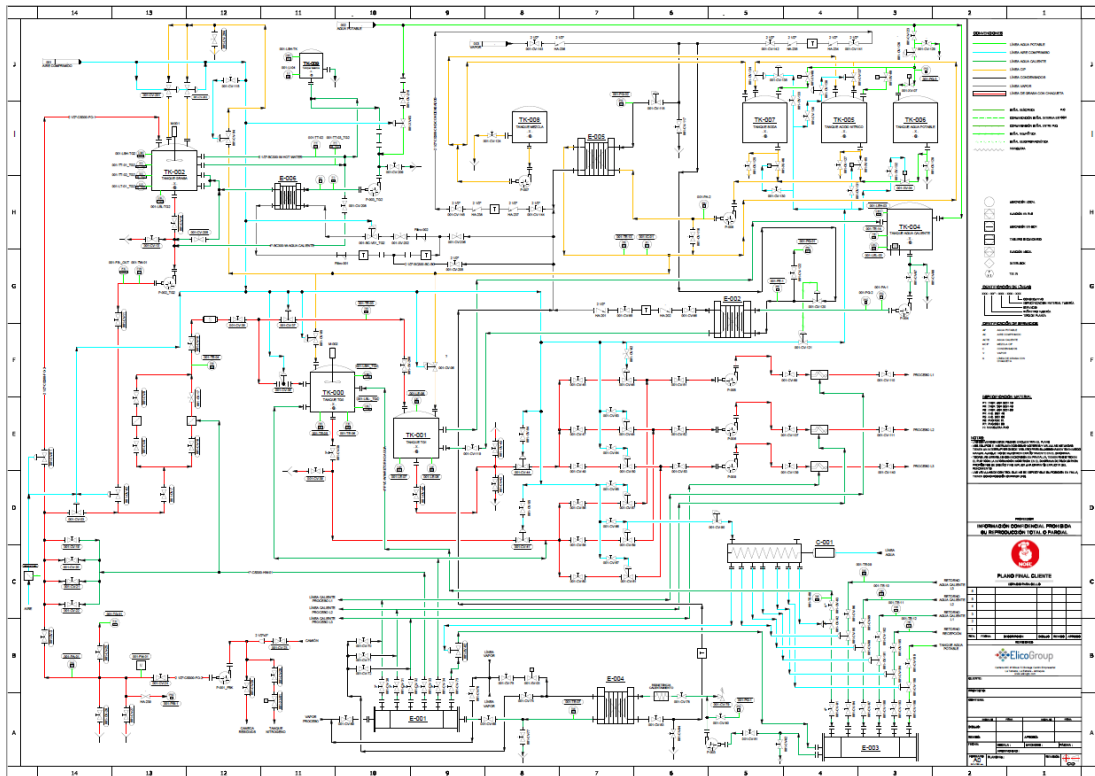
Muestra el P&iD, Ruteo de grasa planta Compañía de galletas Noel, Medellín. Diseño en AutoCAD Plant 3D. (Fuente: Elaboración propia).
